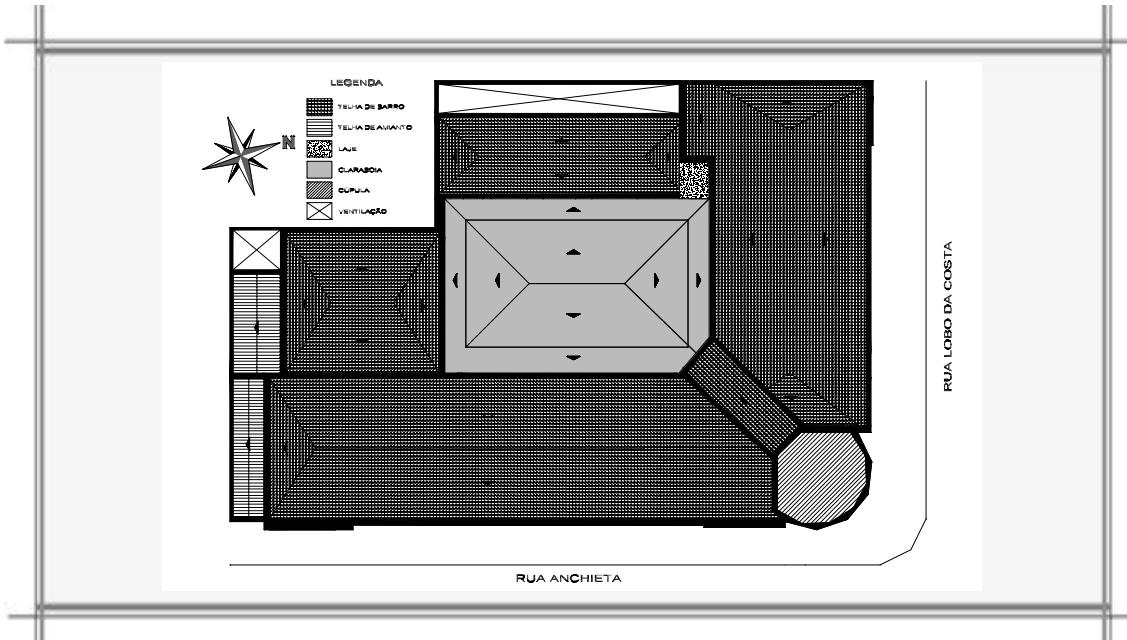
Planta de Cobertura. Desenho: Cristiane Müller.
